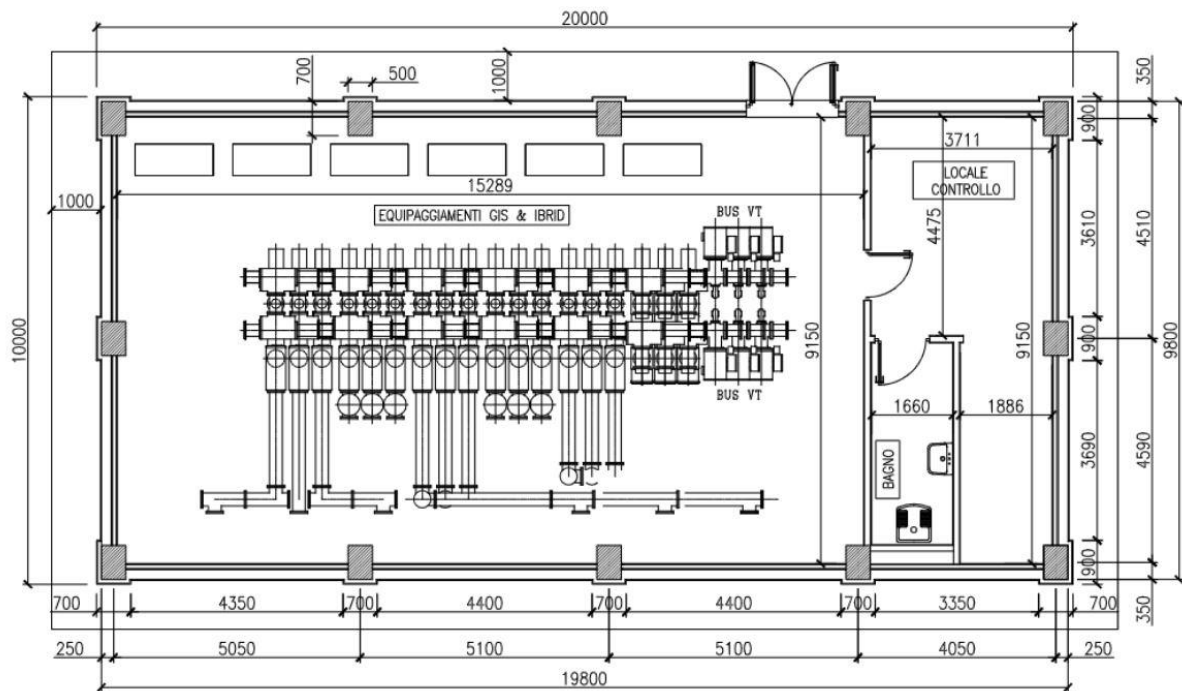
Vista in pianta tipico stazione di sezionamento
